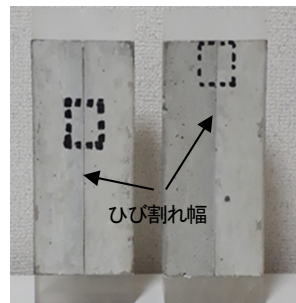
人工ひび割れ供試体 (点線枠内：計測箇所)
